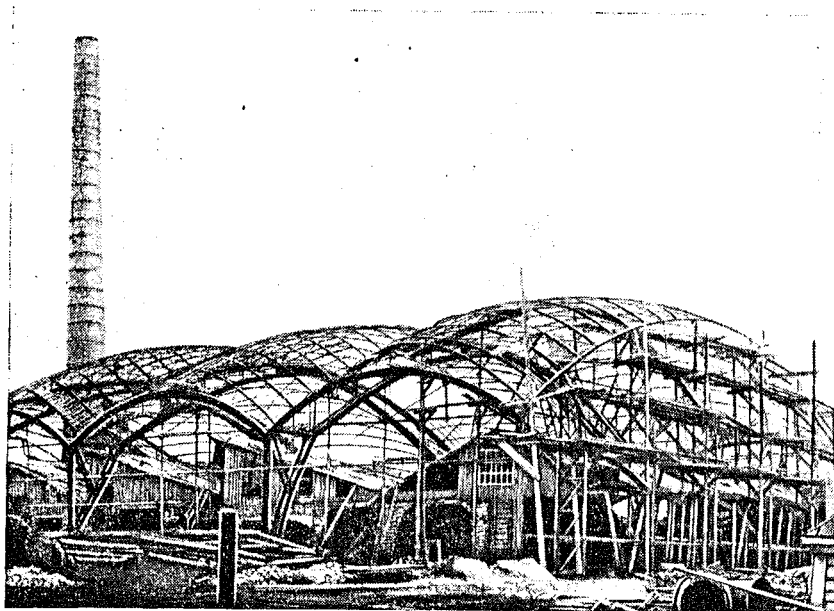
Stabwerksdach mit drei Spannweiten und doppelter Krümmung, gebaut 1898 im Vyksuner Werk.
